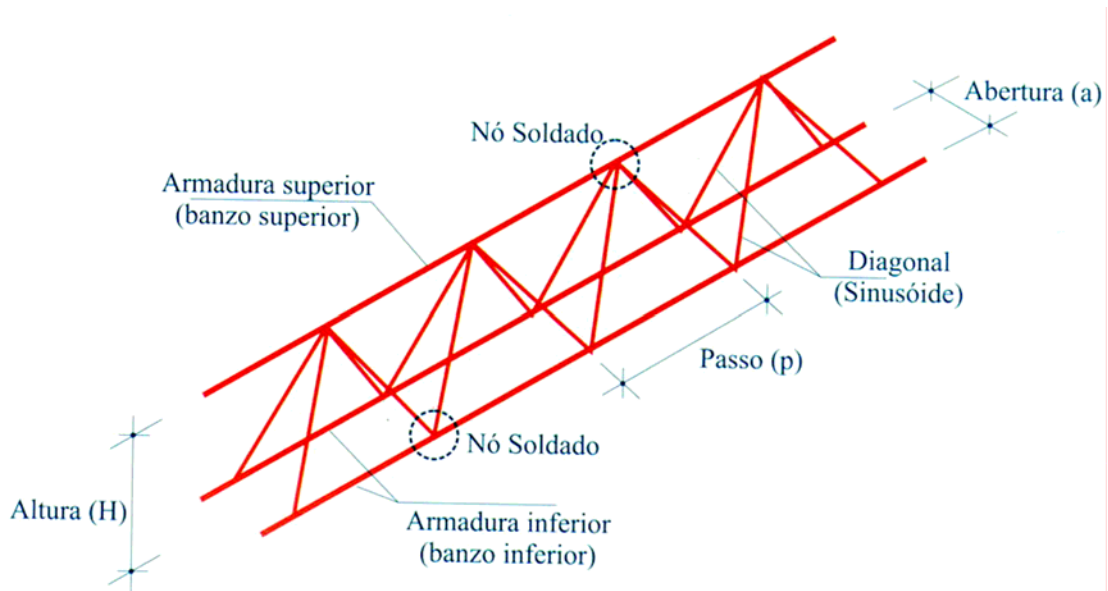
Armação em forma de treliça espacial (LAJES FAULIM, 1998).
